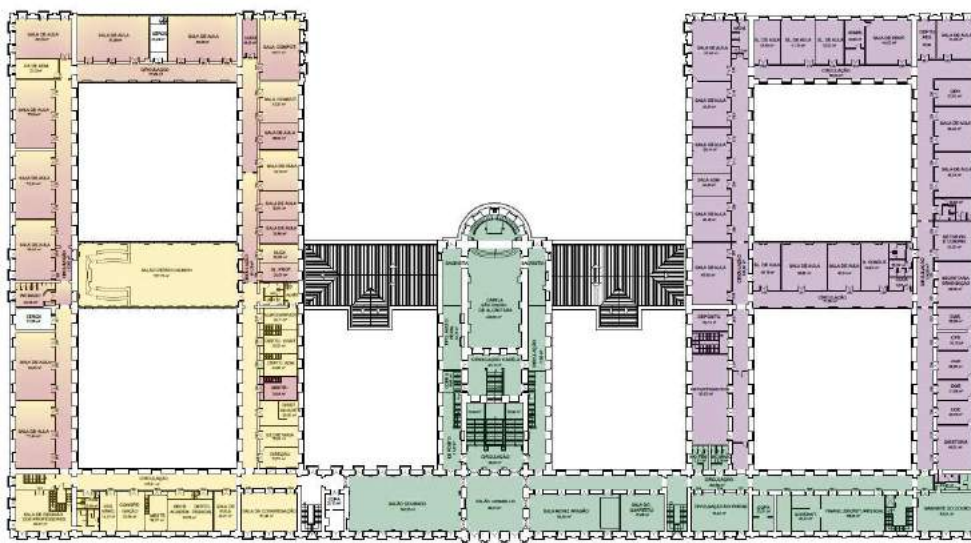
Planta de Uso e Ocupação do 2º pavimento do Palácio universitário /UFRJ
